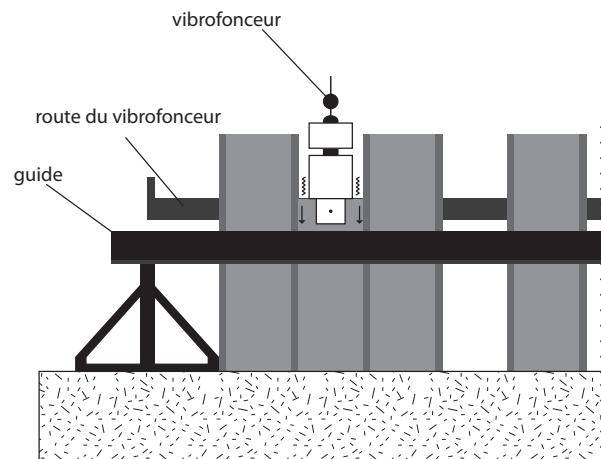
Mise en place d'un rideau de palplanches par vibrofonçage de manière alternée
